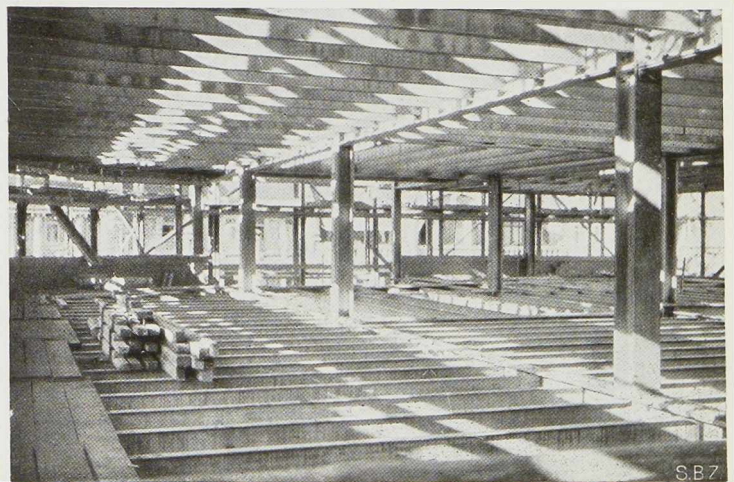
Vue d'une colonne au niveau du plancher du premier étage.
